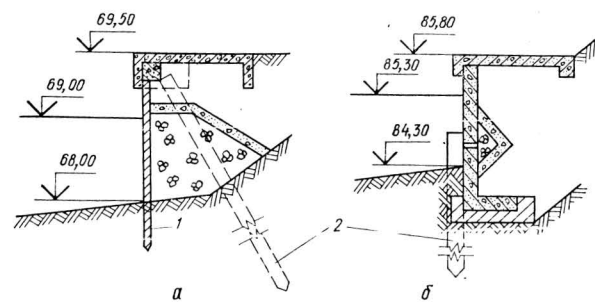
Крепление берега пруда: свайным рядом с шпунтовой (а) и железобетонной (б) стенами: 1 — шпунт; 2 — свая.
